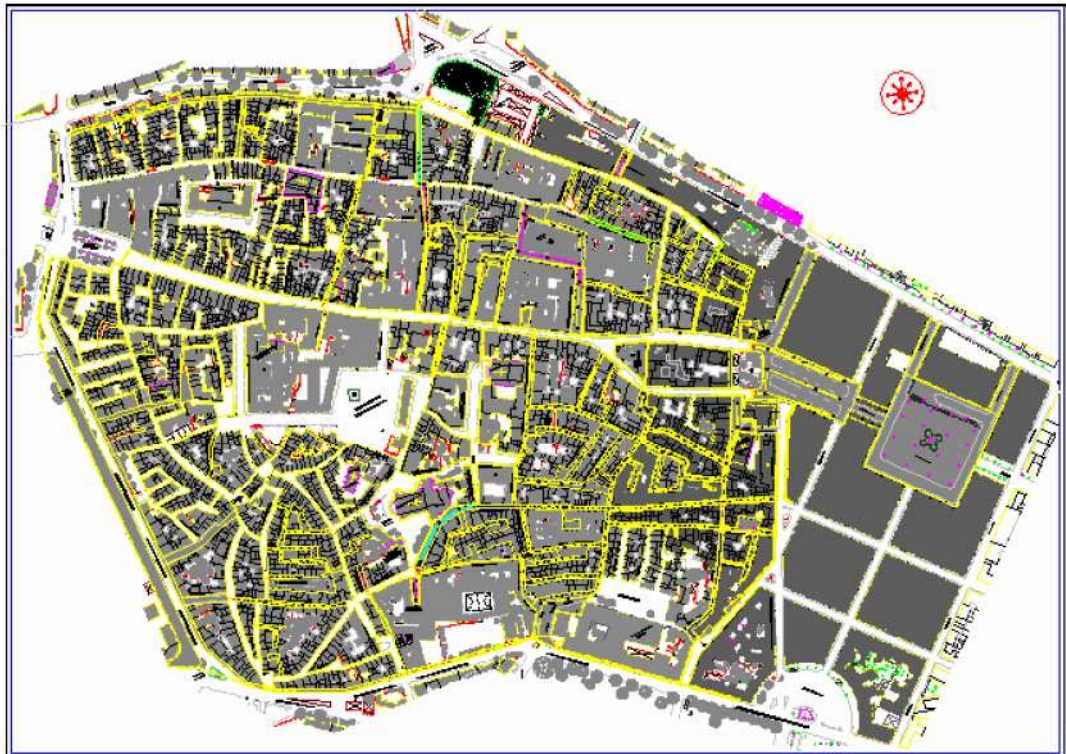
Planimetria del centro storico di Sassari e dell'area di intervento. In giallo è segnato il tracciato della rete per le opere bianche.
